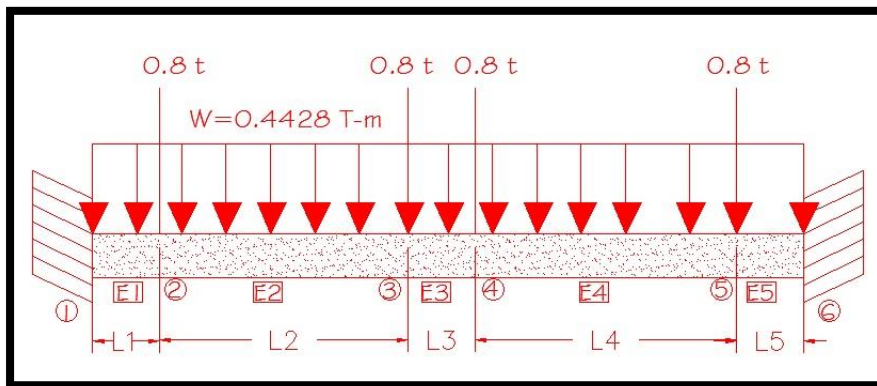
Modelo de viga de escalera con cargas viva y muerta.
